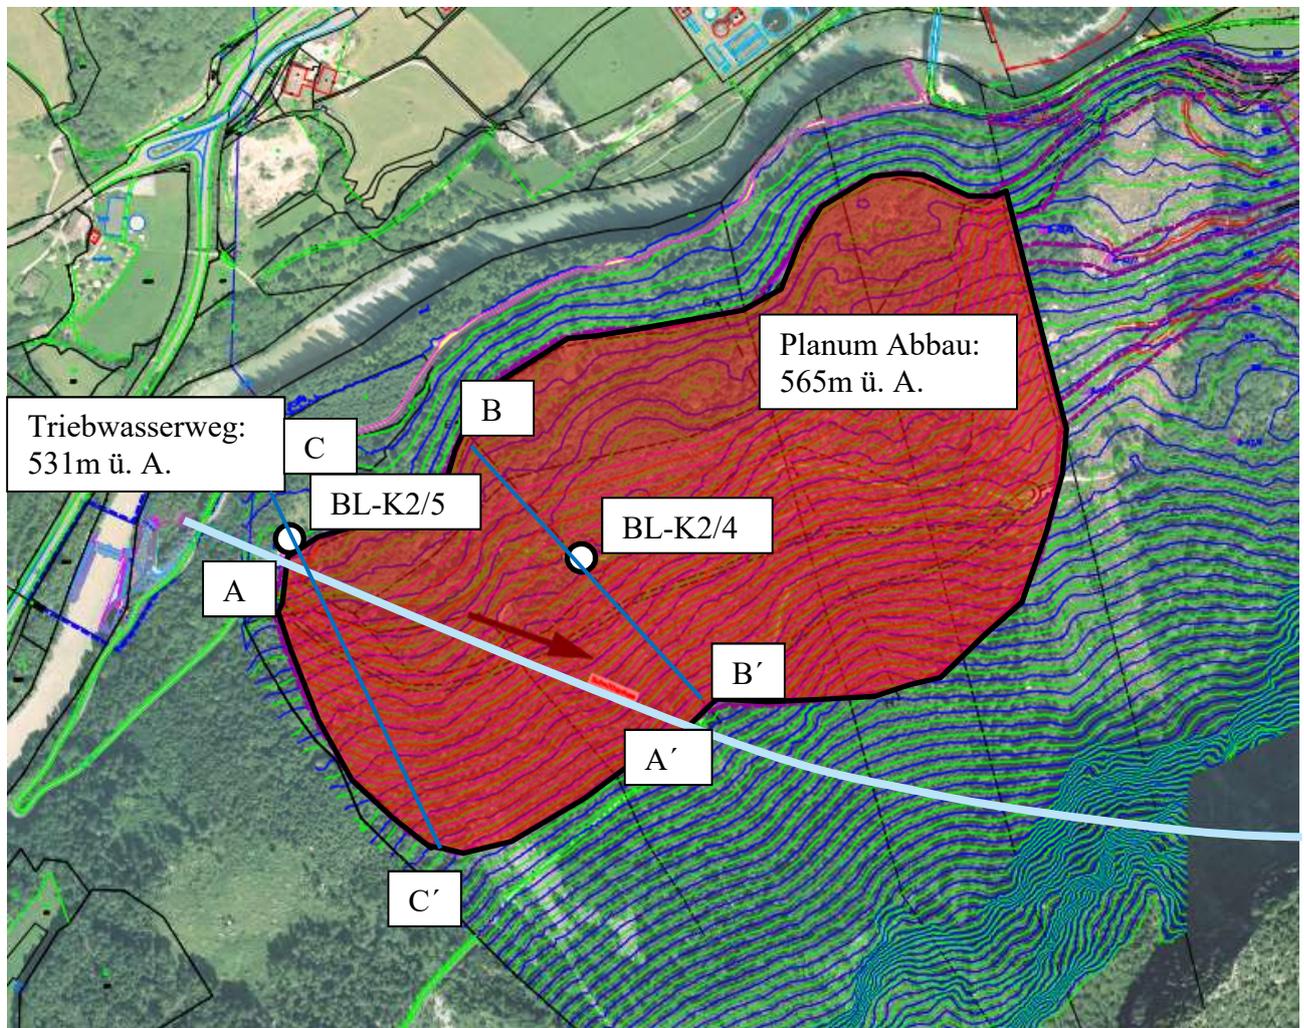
Lageplan des geplanten Abbaubereiches der Flatscher Erdbau & Schotterwerk Ges.m.b.H (rote Fläche) und Triebwasserstollen Wasserkraft Schneizlreuth GmbH & Co. lt. übermittelter Daten von REGIOPLAN INGENIEURE Salzburg GmbH vom 01.03.2019; Triebwasserstollen (hellblaue Linie); Schnitt A-A' entlang der Trasse (hellblaue Linie), Schnitt B-B' und C-C' (dunkelblaue Linien) und Bohrungen BL-K2/4 und BL-K2/5 zur Erkundung der Erweiterung des Abbaubereiches (Lockergesteinsabbau Köstlerwald Explorationsbohrungen 2016; Dr. phil. Gerhard Feitzinger)
